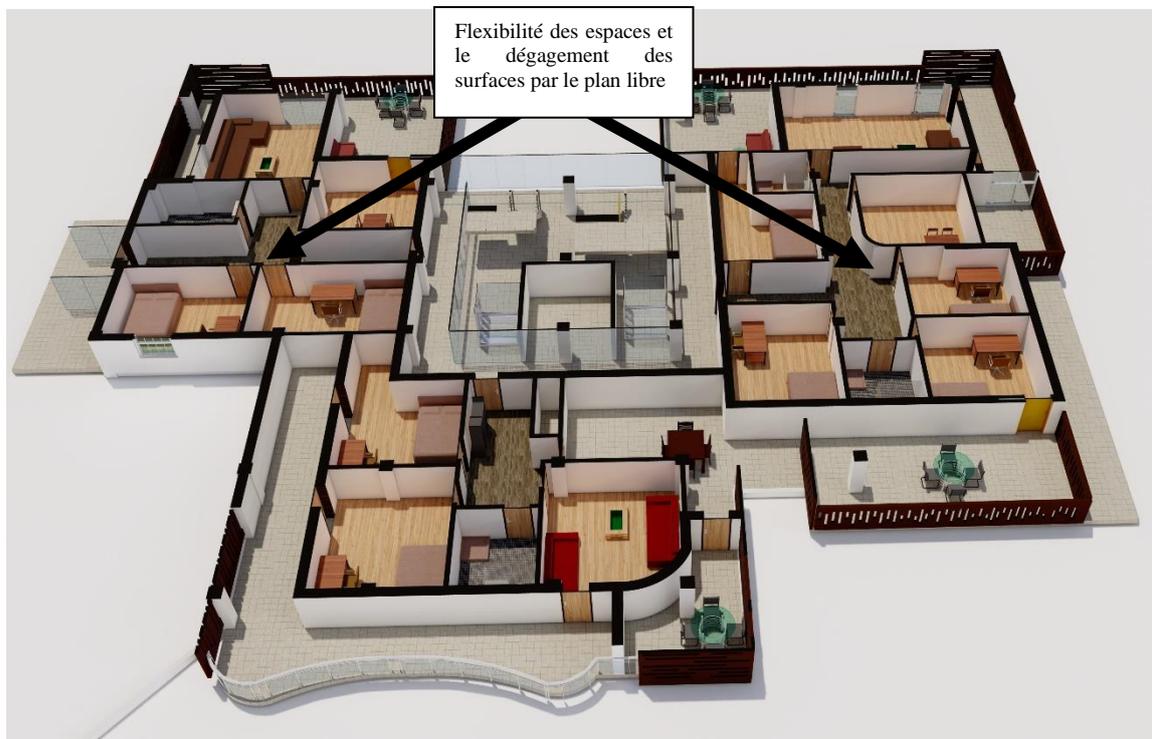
plan perspective du èème étage logements. source: travail d'auteur
